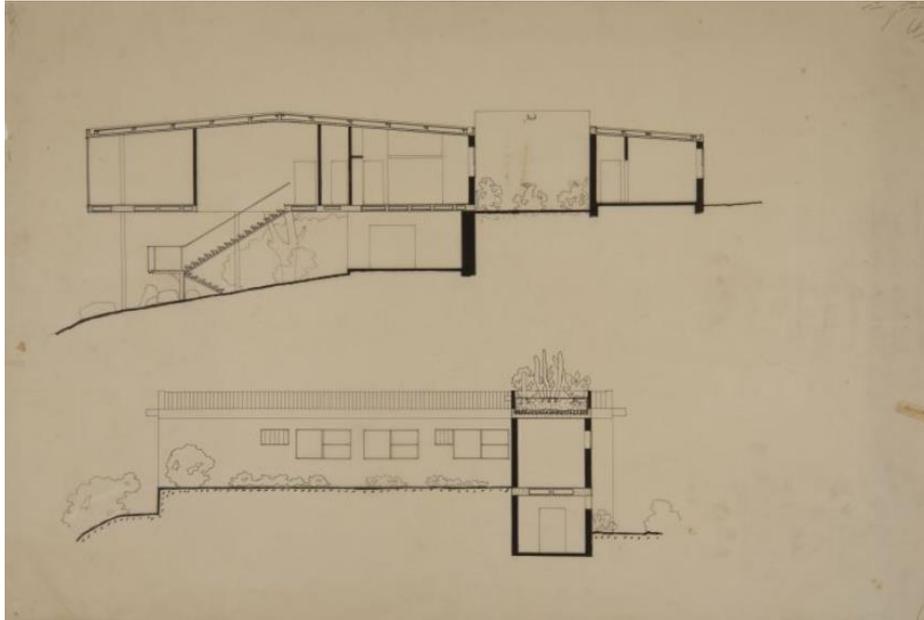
corte longitudinal y transversal de la Casa de Vidrio, 1951, archivo Instituto Bardi
